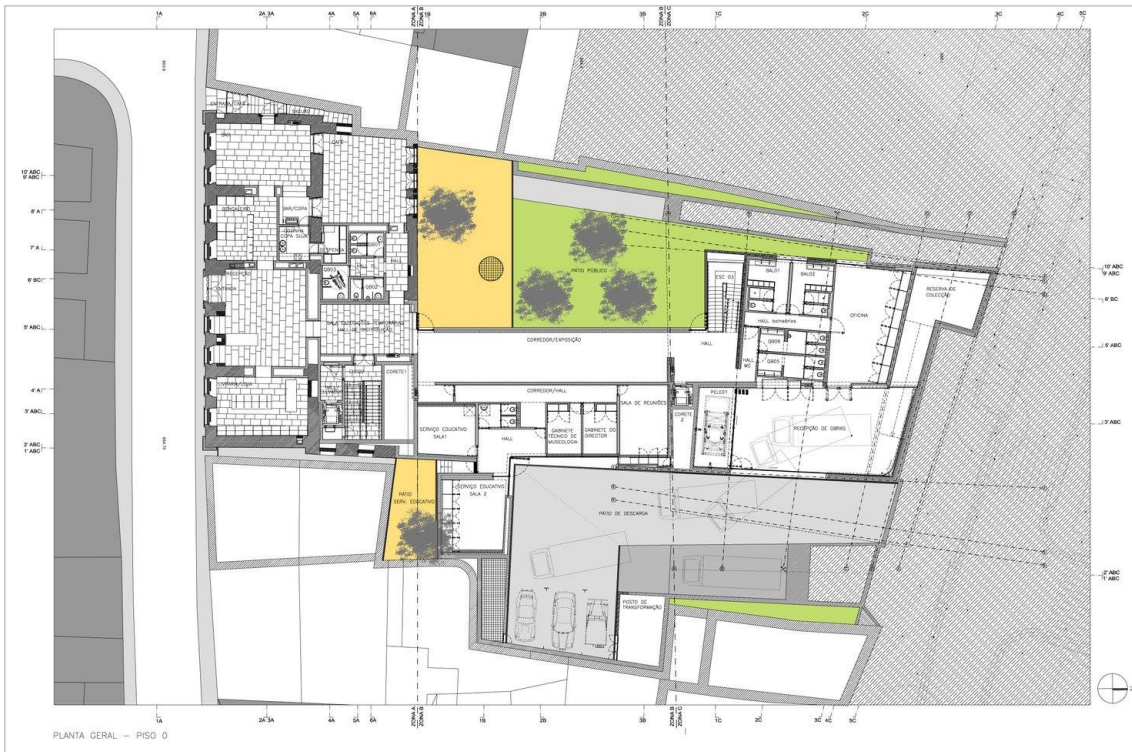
Planta térrea do Centro de Arte Contemporânea Graça Morais.
